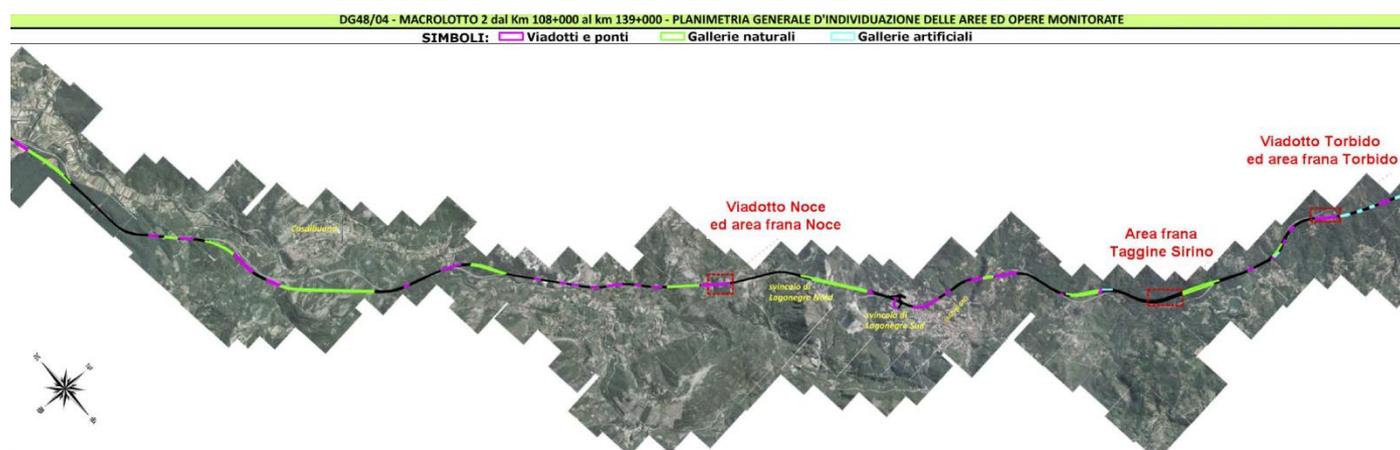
Ubicazione planimetrica dei siti di monitoraggio del Macrolotto 2.
